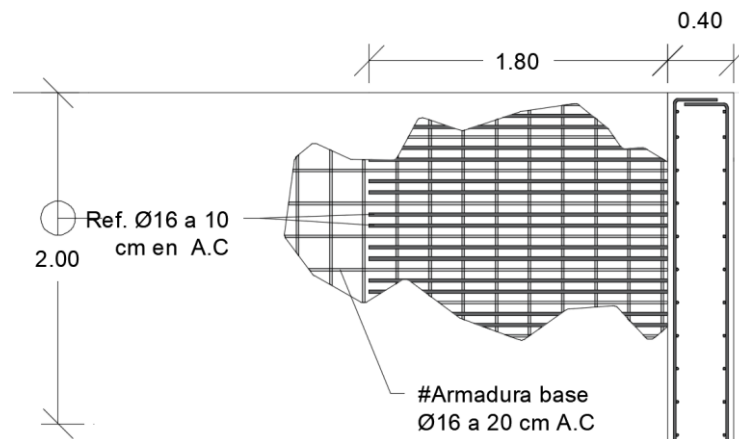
Refuerzo sobre armadura base en Muro Interno 3 (armadura horizontal)
